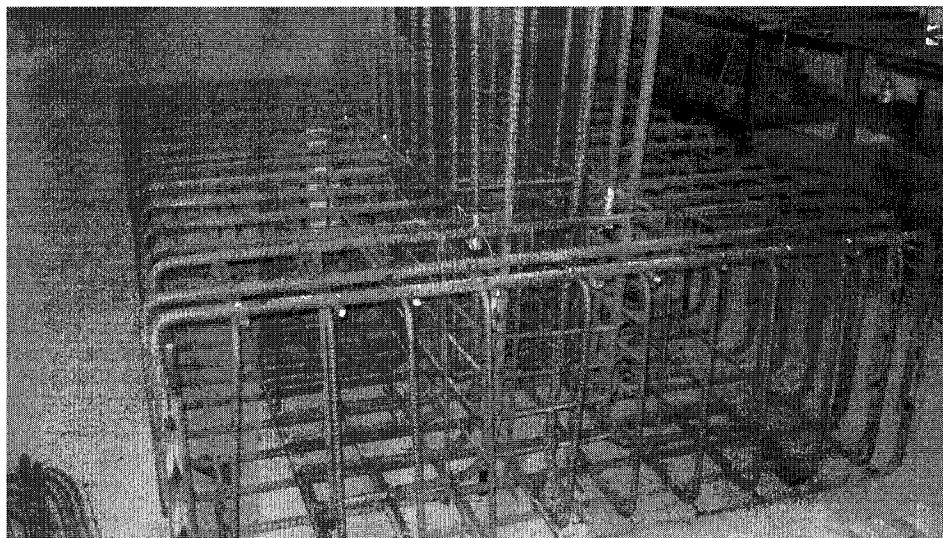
Cage d'armature de la semelle 3 terminée
